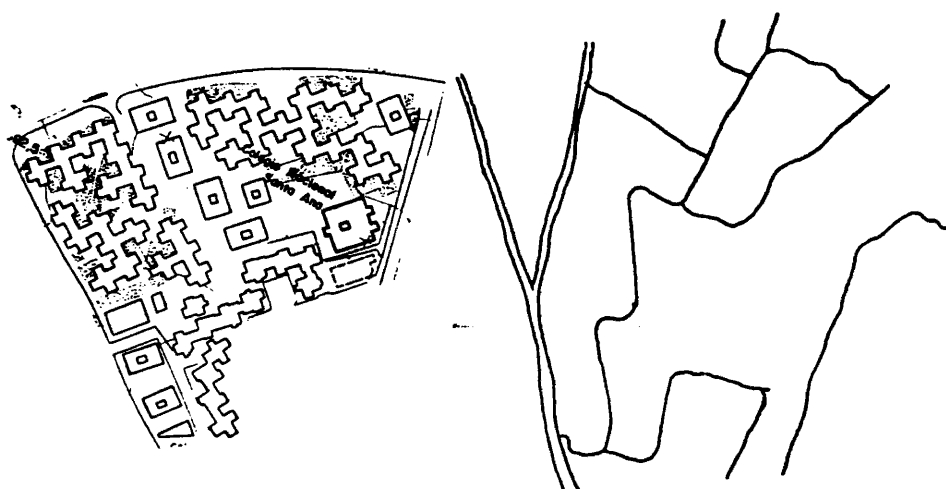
Urb. Buenos Aires y la Milagrosa. Promociones de INAMSA y ENCO.SA. Alcobendas Estructura rural
